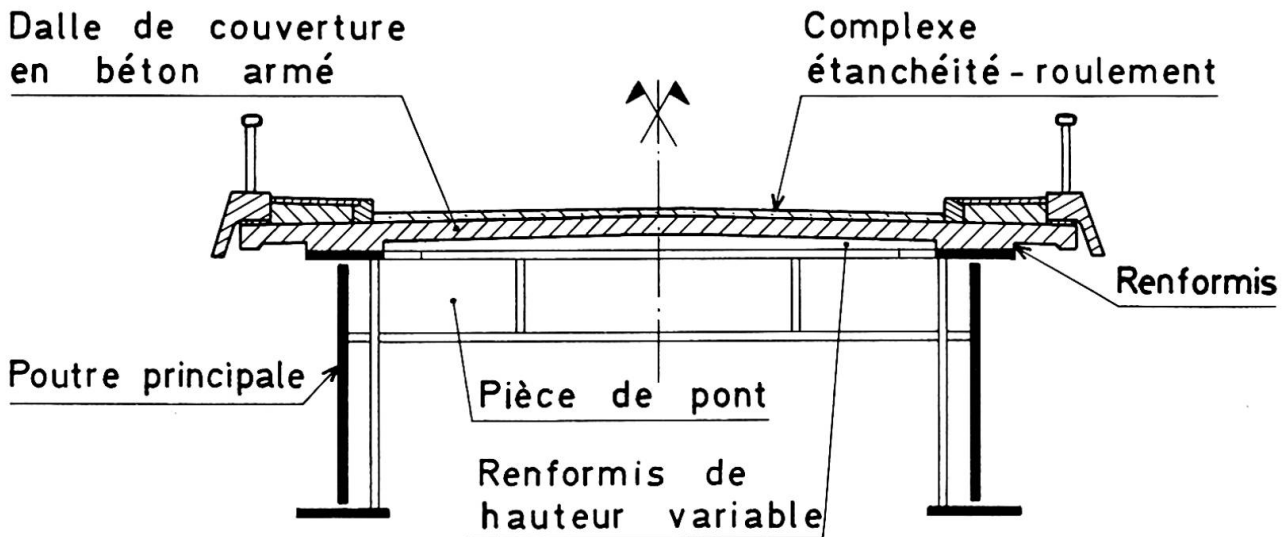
Pont à deux poutres sous chaussée et pièces de pont.
